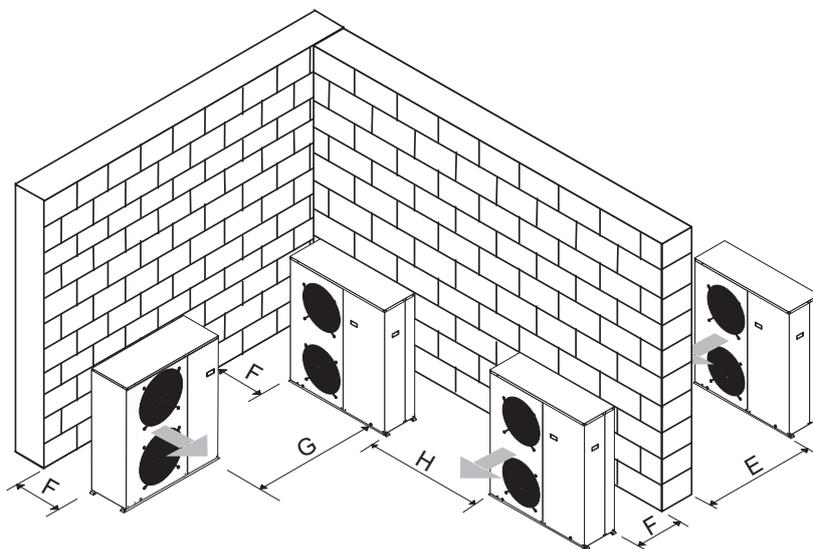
spazi di rispetto di unità installate rispetto ai muri.
